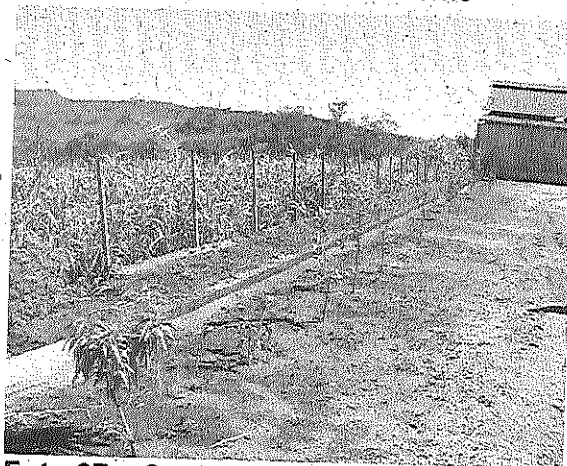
Cortina arbórea e sistema de drenagem pluvial.
